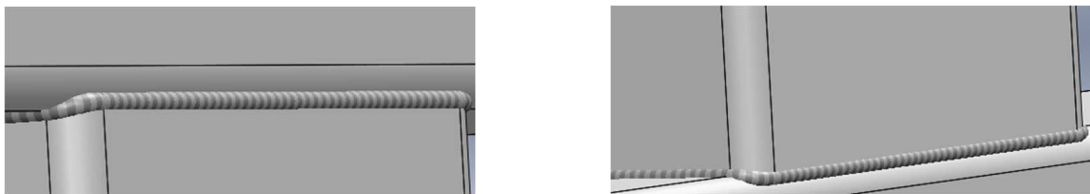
Ligações soldadas do tubo 300×200×8 mm.
